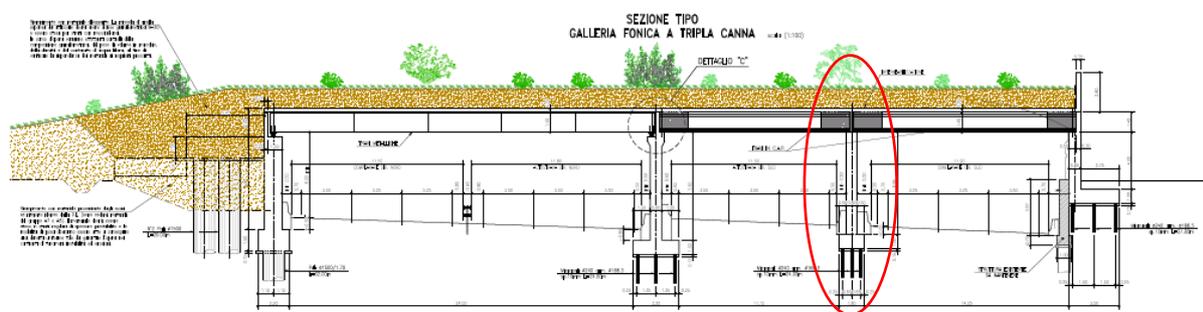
galleria San Donnino, individuazione setto centrale da eliminare
